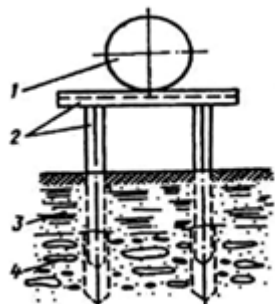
Схема надземної прокладки газонафтопроводів:
